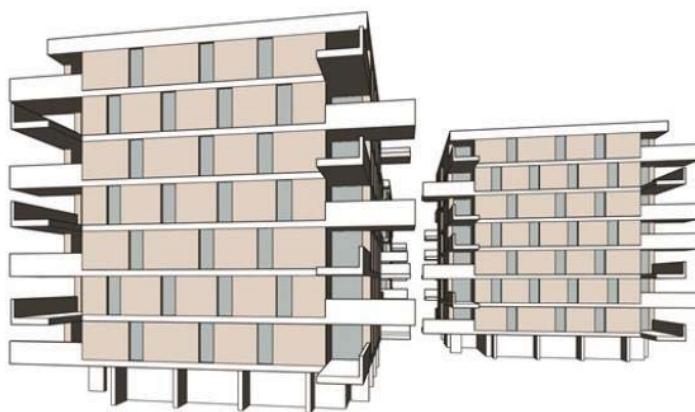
Ansicht Grundrisstyp Prunkhaus 2<sup>291</sup>
